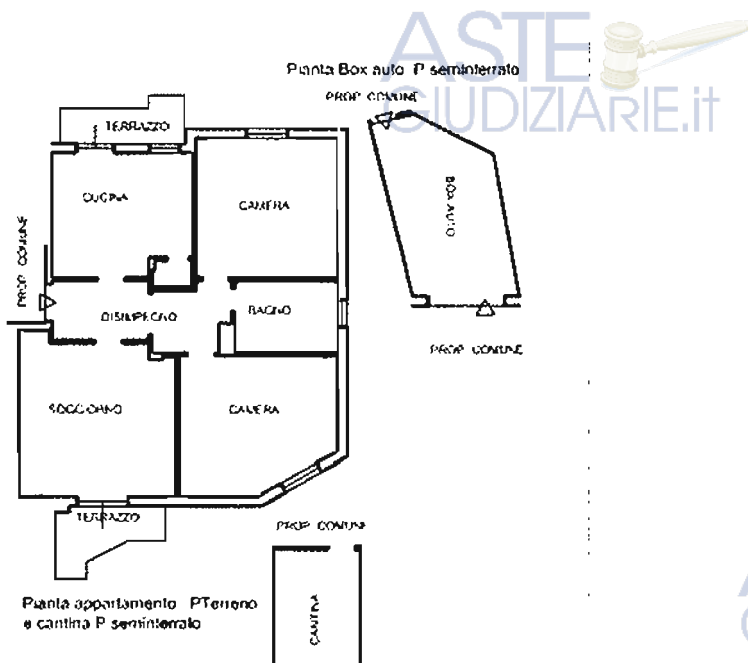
schemi planimetrici appartamento, cantina e box auto (elaborato non in scala)
